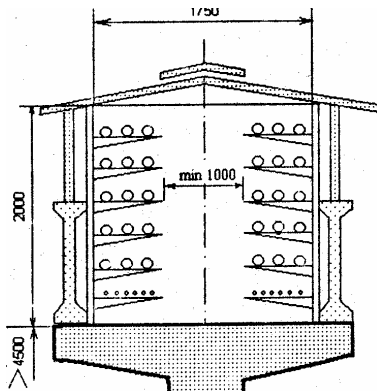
Кабельная эстакада (галерея) из сборного железобетона, проходная с двусторонним обслуживанием
